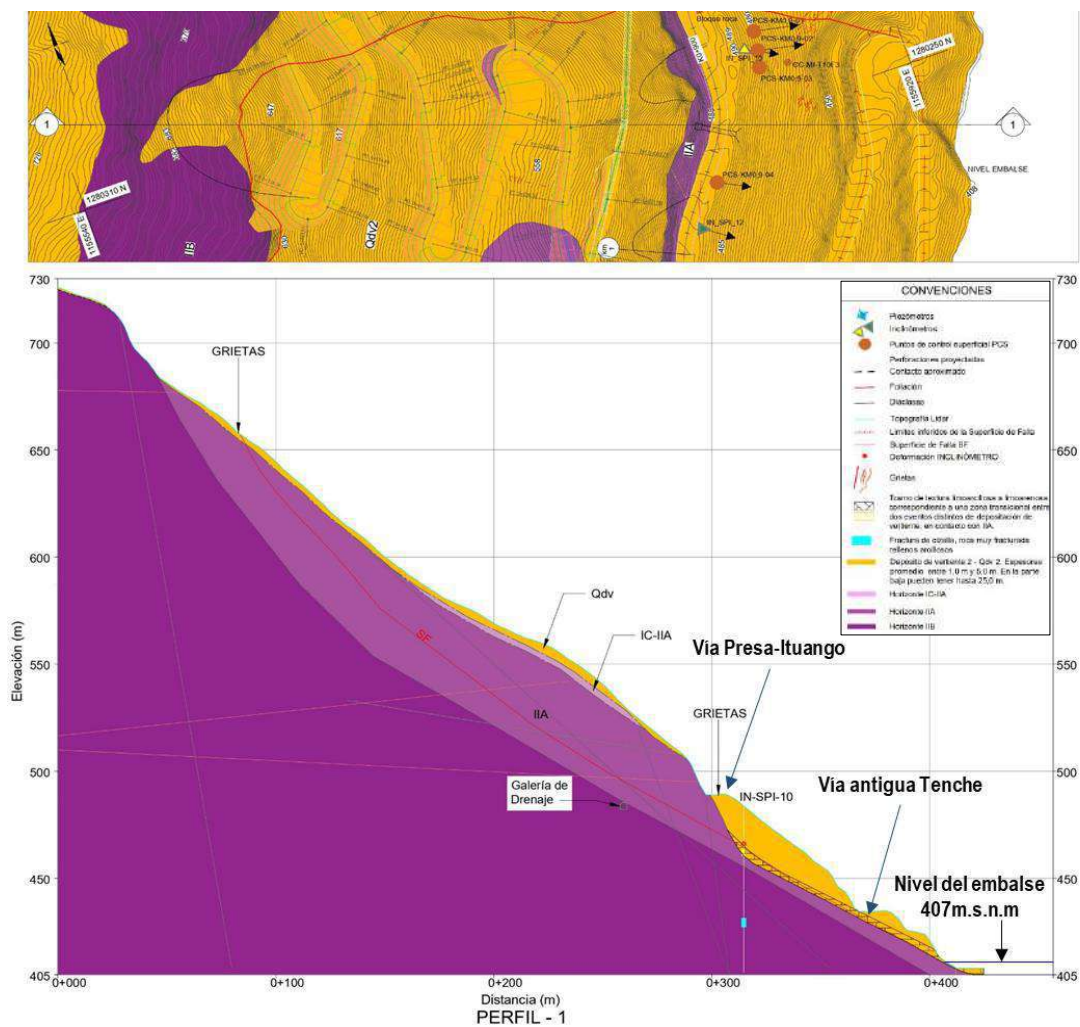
Perfil geológico proyectado Sector Norte (Perfil 1).
